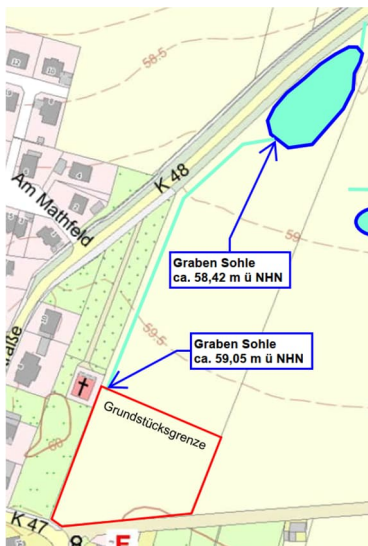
Anlage 1 – Ausschnitt Lageplan Graben und Regenrückhaltebecken
